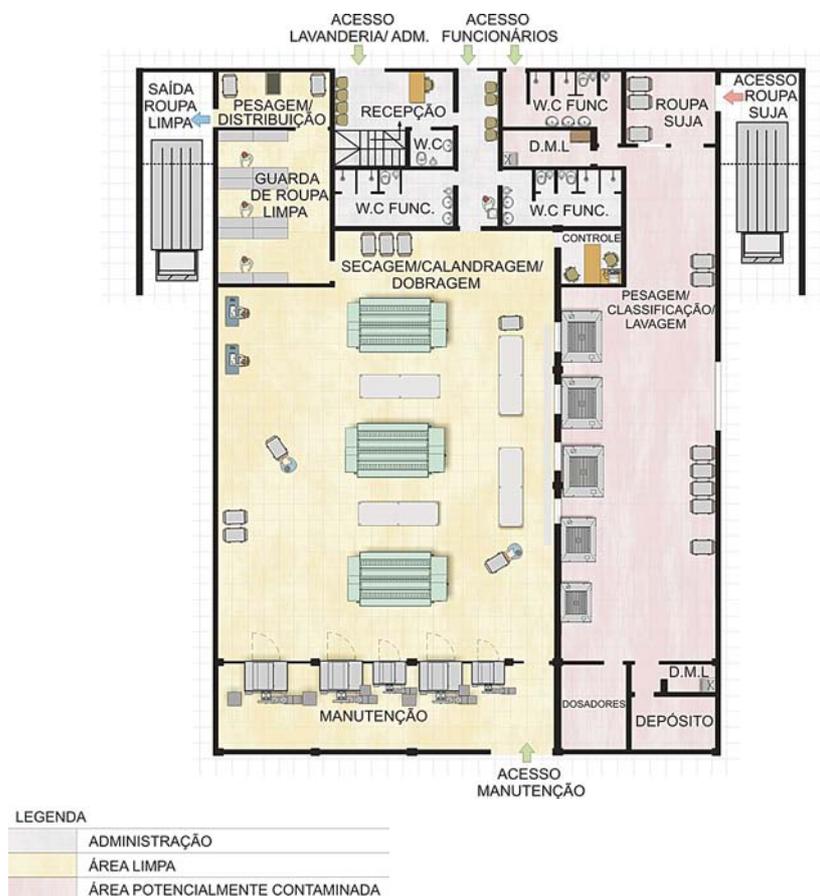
Planta baixa e layout do pavimento térreo e zoneamento da área de produção.
